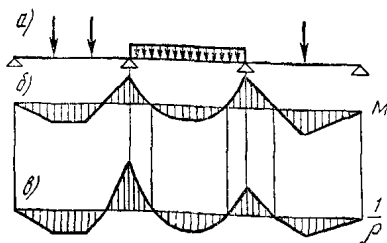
Эпюры изгибающих моментов и кривизны для железобетонного элемента постоянного сечения
